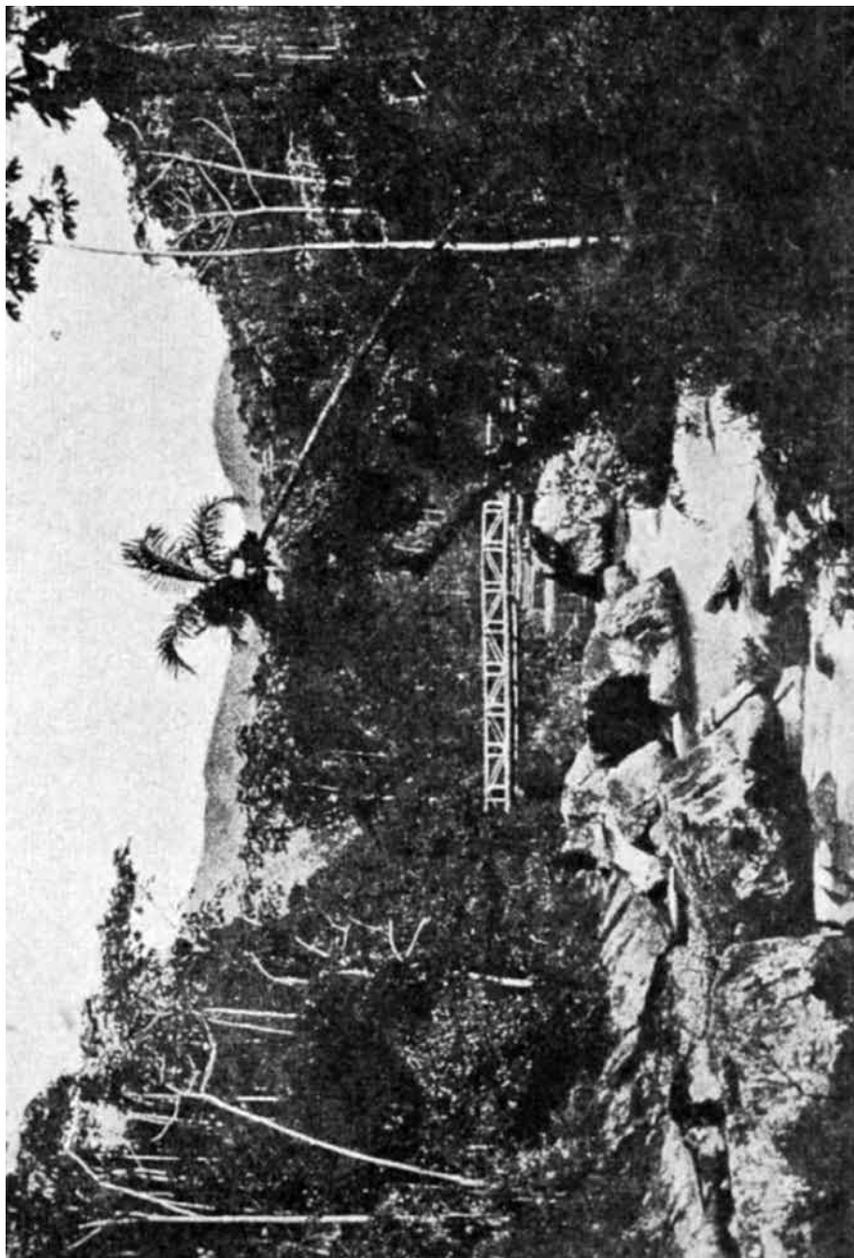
Ponte sobre o Rio Santa Maria. Ponta de Aquidabã.
